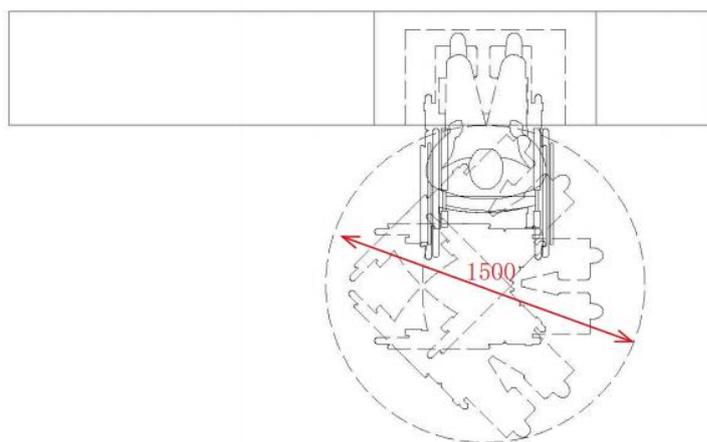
低位服务设施前轮椅回转空间示意图（单位：mm）
